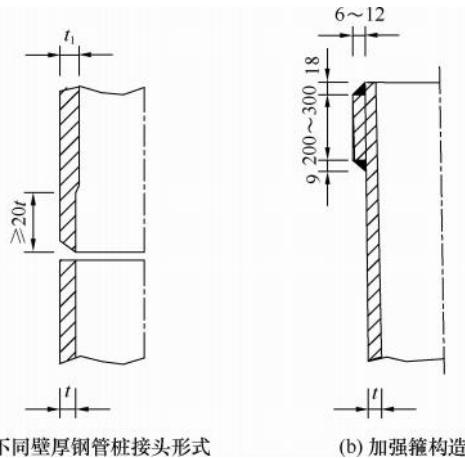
钢管桩不同壁厚接桩及加强箍构造示意图 (单位: mm)
